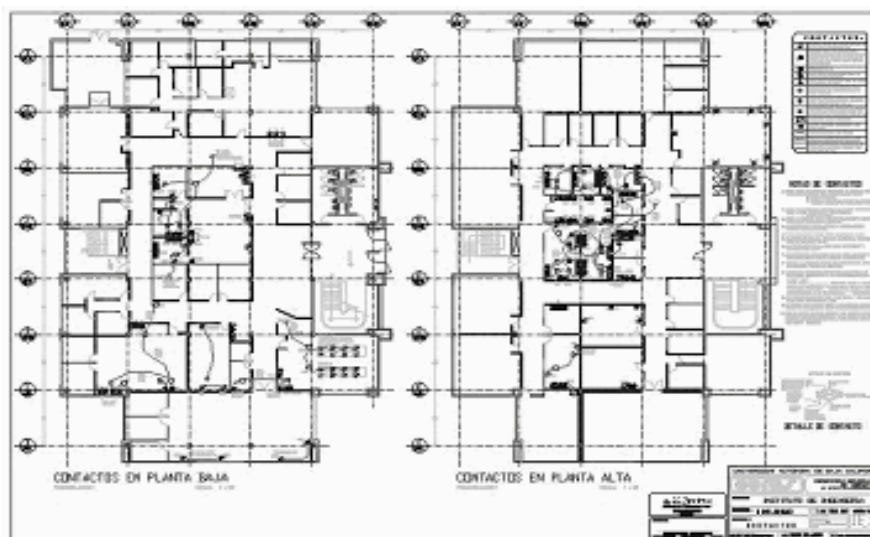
Plano correspondiente a la planta baja y alta del I.I.
